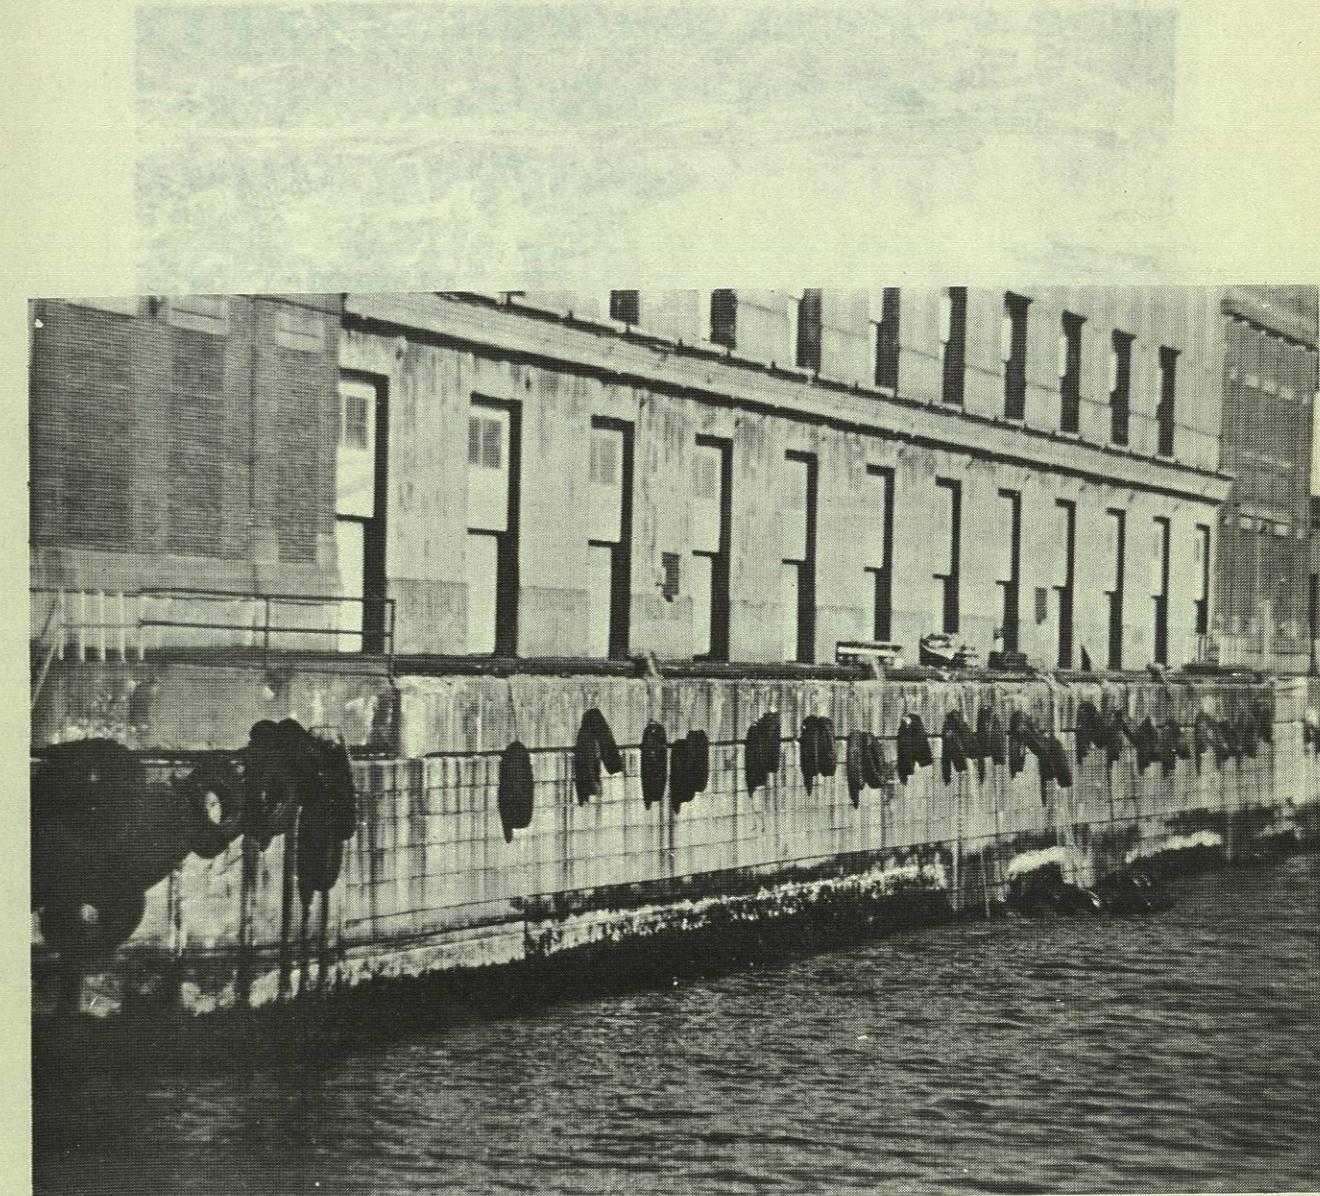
Sección Típica de una pared de fachada de granito en marea baja en el lado sur del Muelle 23, cerca de la esquina suroeste. Se han requerido muy pocas reparaciones en las juntas (Foto 1979).
